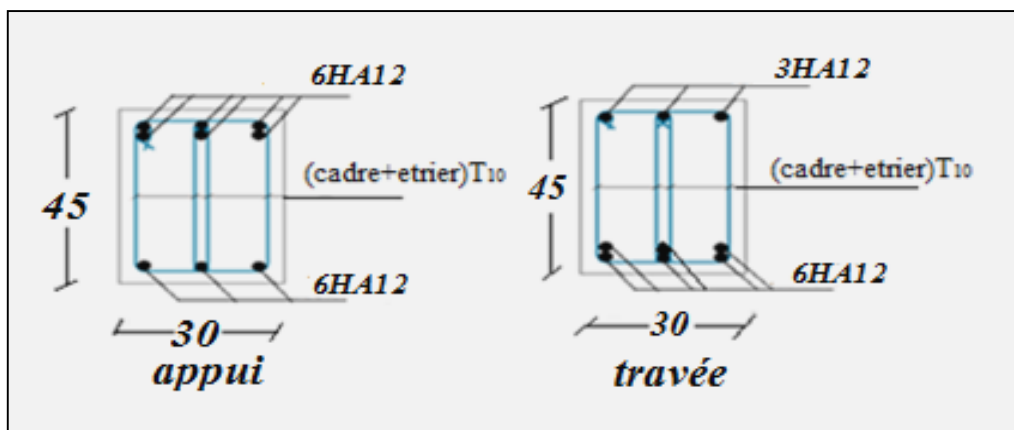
Schéma de ferrailage des poutres secondaires (terrasse).
